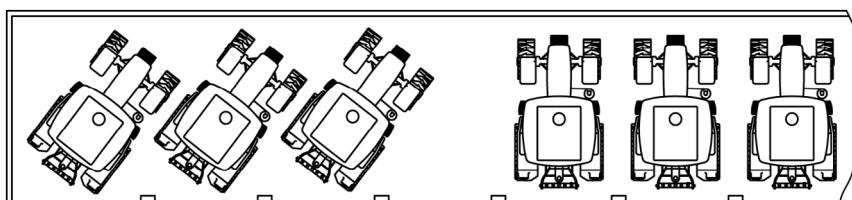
Sistem parkiranja u pravcu ose garaže
